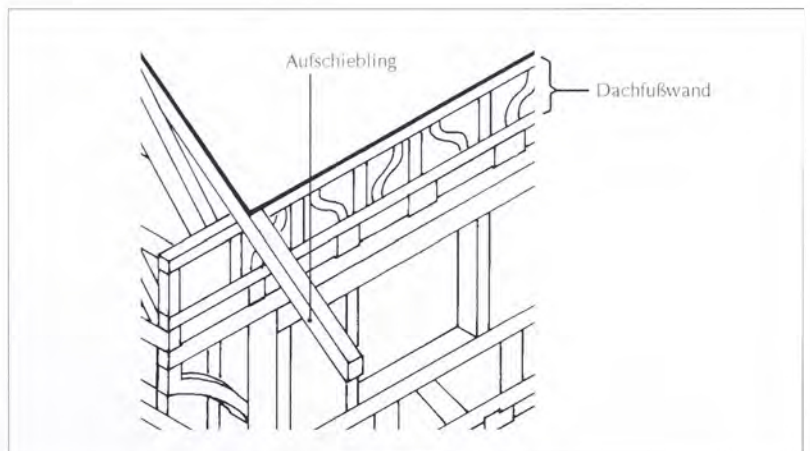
Haus mit Kniegeschoss und ausgebildeter Dachfußwand.
